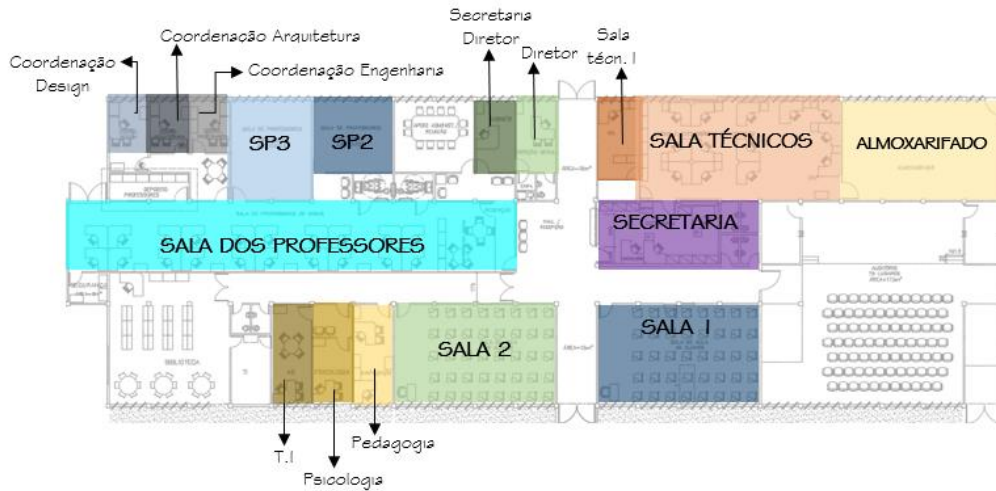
Planta Técnica Bloco 1– IFMG Santa Luzia
